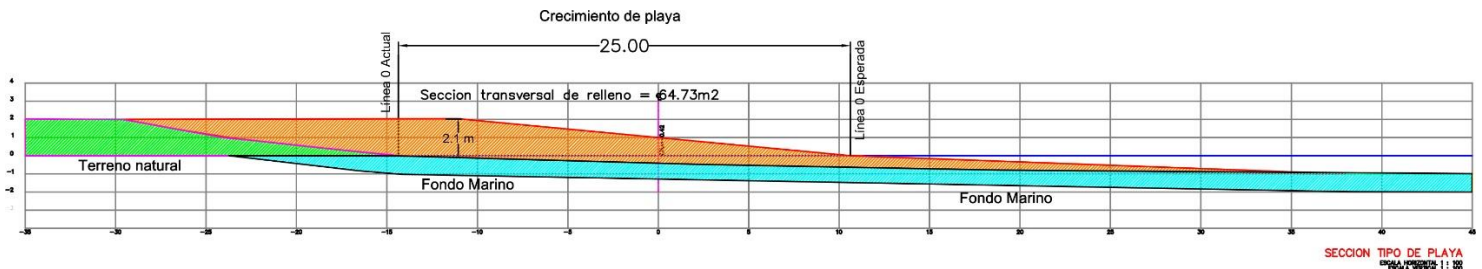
Corte transversal de una sección tipo del relleno de arena.
